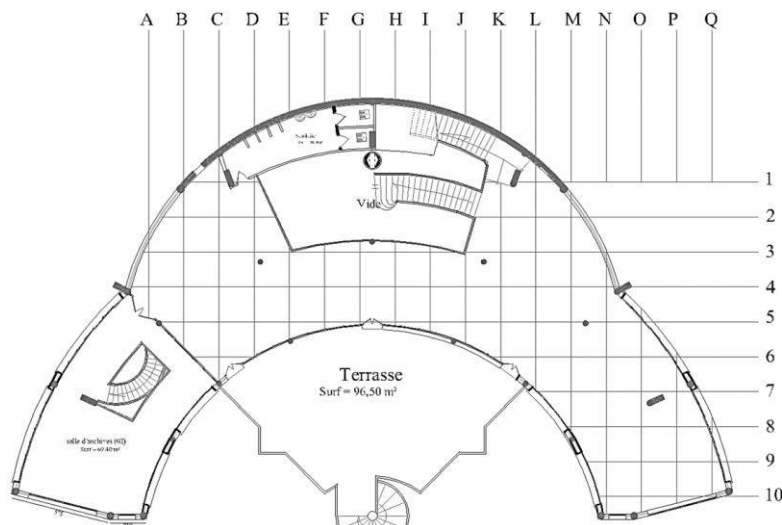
La grille des mesures sur le plan de la salle d'exposition. (Source : Auteur, 2021)
